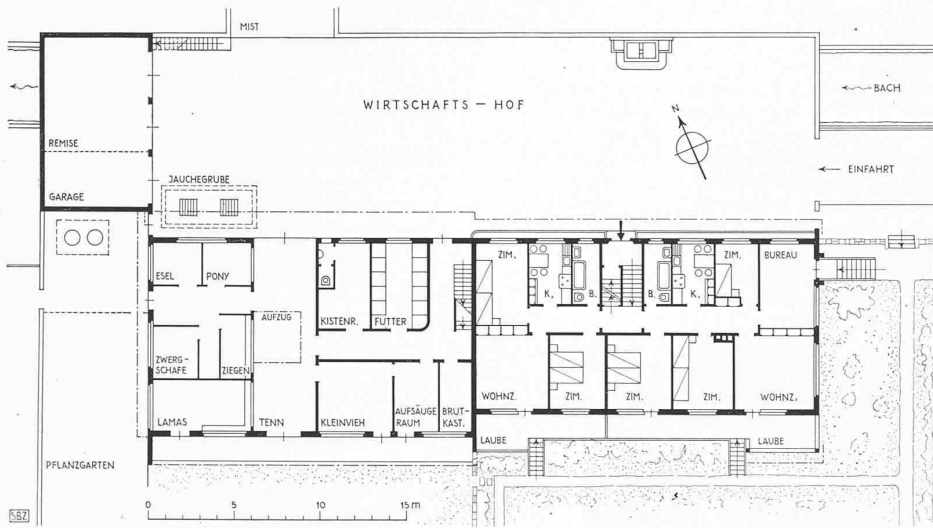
und 17. Grundriss und Ansicht vom Oekonomiegebäude, 1:400. — Arch. E. HOSTETTLER
